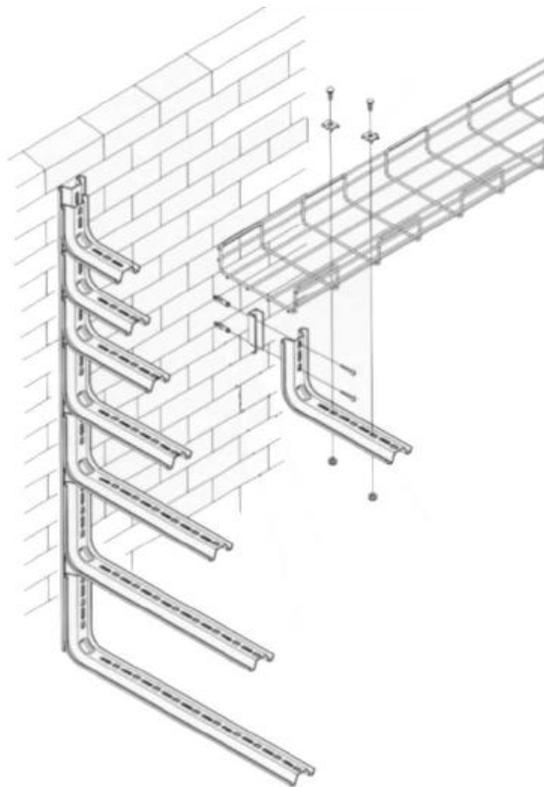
Conducción de cables a doble bandeja, con suspensión en techo.
